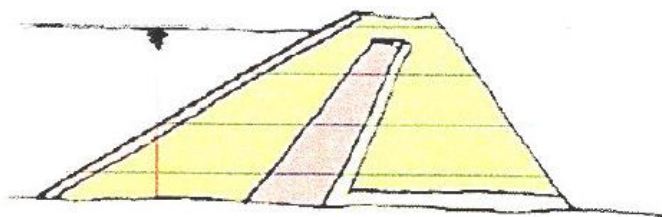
Barragem de terra zonada. Adaptado de (fenix.tecnico.ulisboa.pt)
